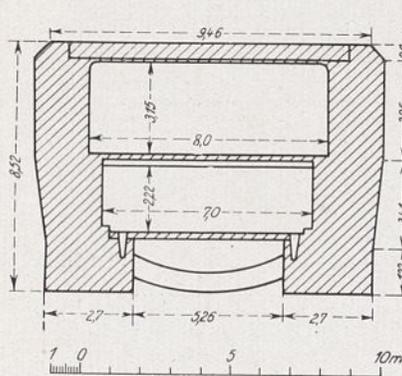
Hauptpersonentunnel mit darunter liegendem Gepäcktunnel.
